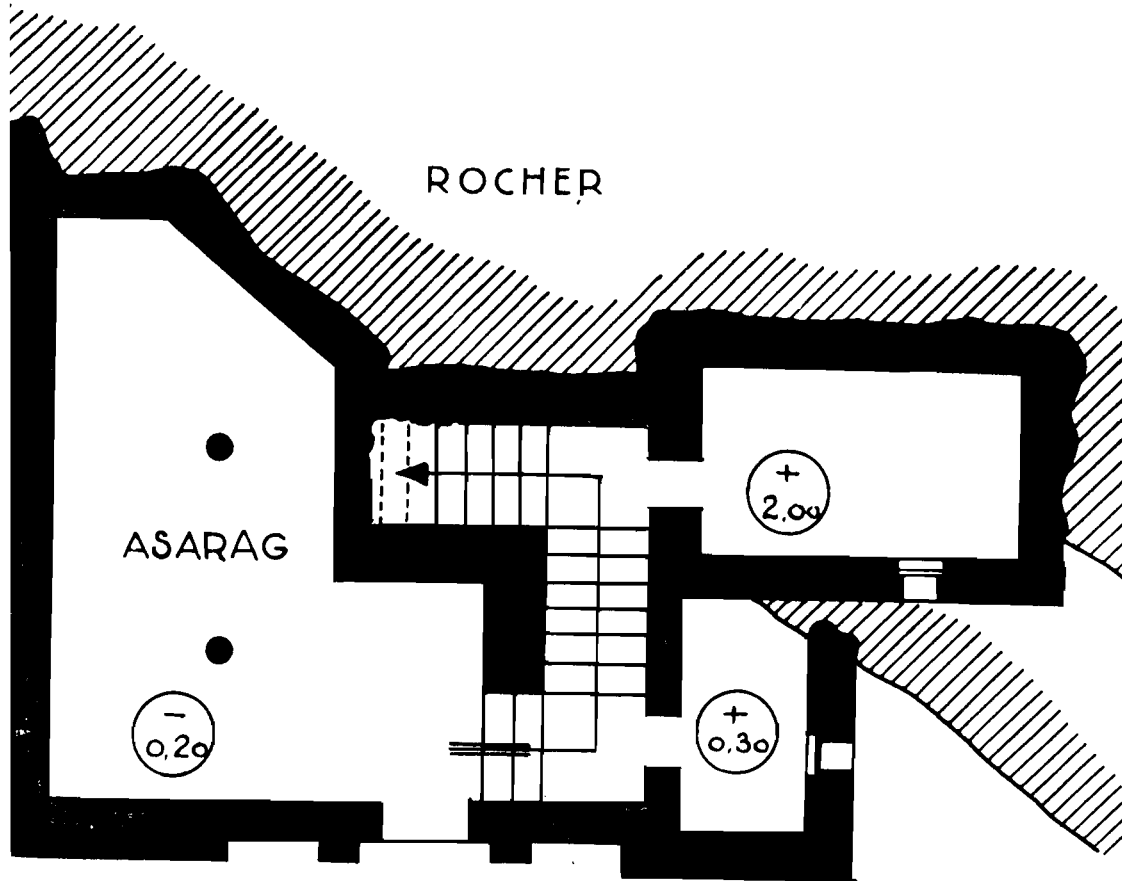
Maison d'Imi-Ane (Tafraout), où les pièces sont disposées par plans décalés autour de l'escalier. Plan du niveau bas.
